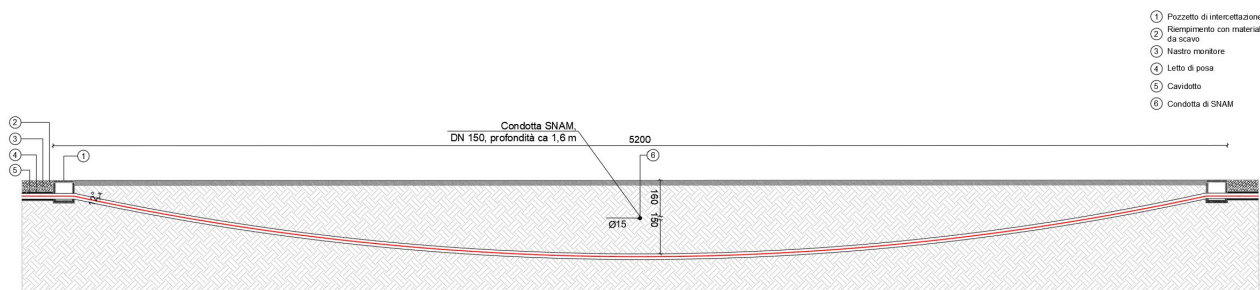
Particolare costruttivo dell'attraversamento tramite TOC
